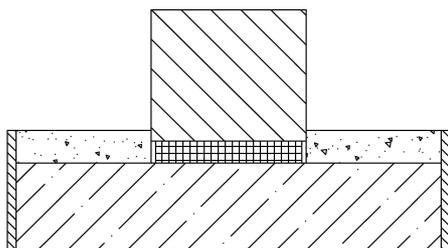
Einschub-Kassetten (Schnittzeichnung)
